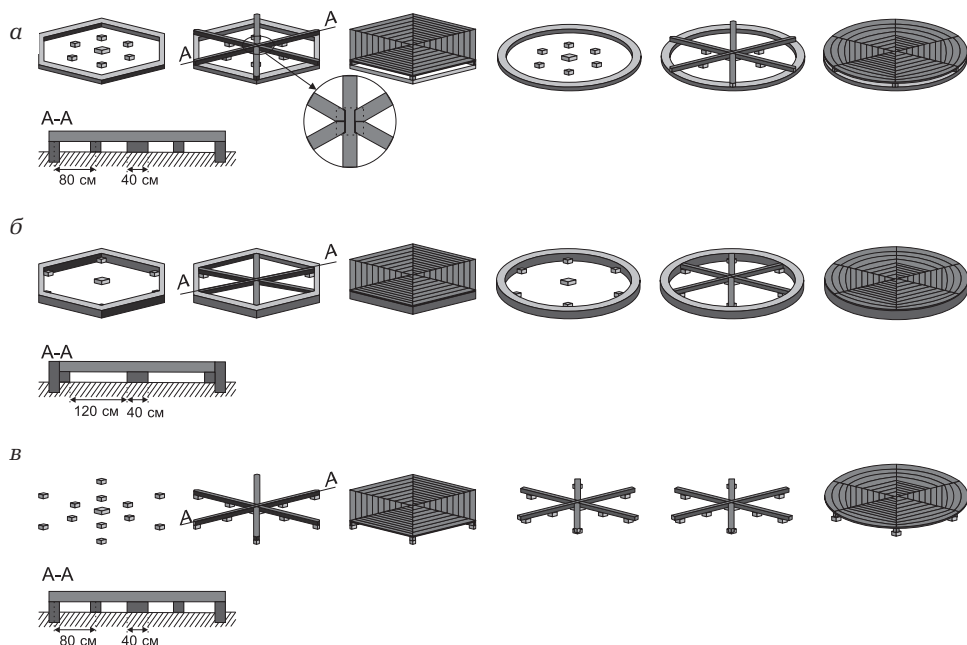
Сегментный настил полов с установкой балок: а — на многоугольный или округлый фундамент; б — на уровне фундамента; в — на столбчатый фундамент
